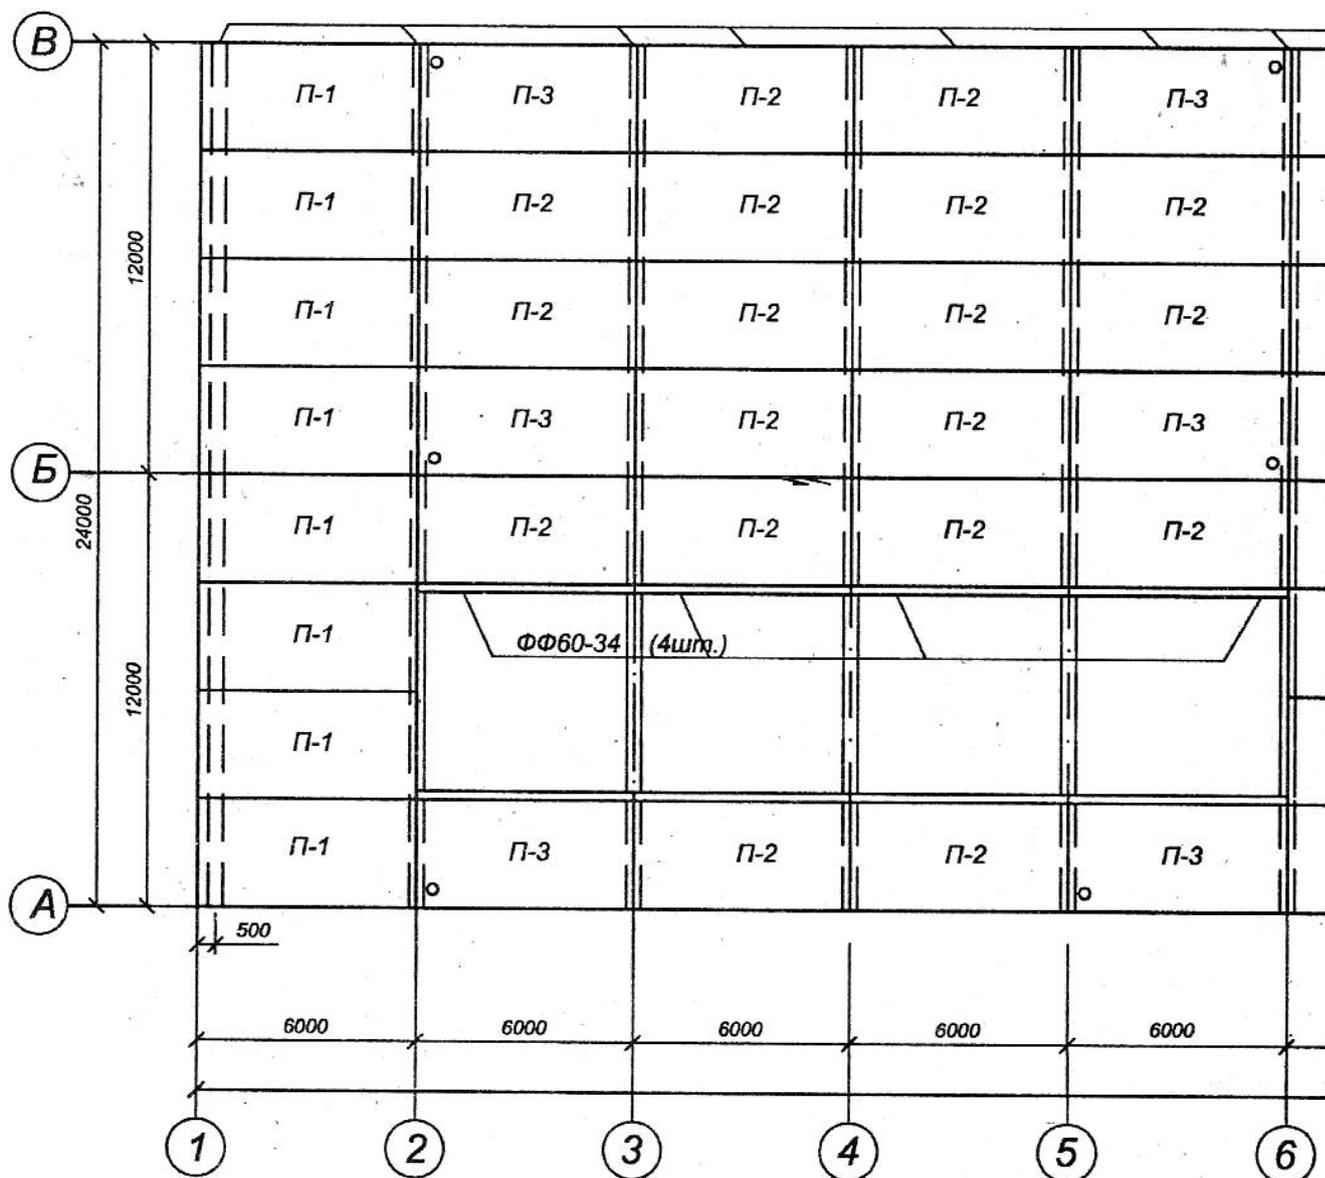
Схема расположения плит покрытий промышленного здания размером 24*72 м
